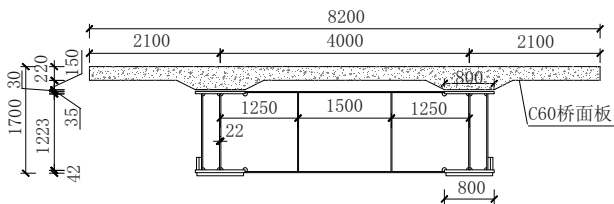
钢板焊接组合梁横断面布置图(单位:mm)
